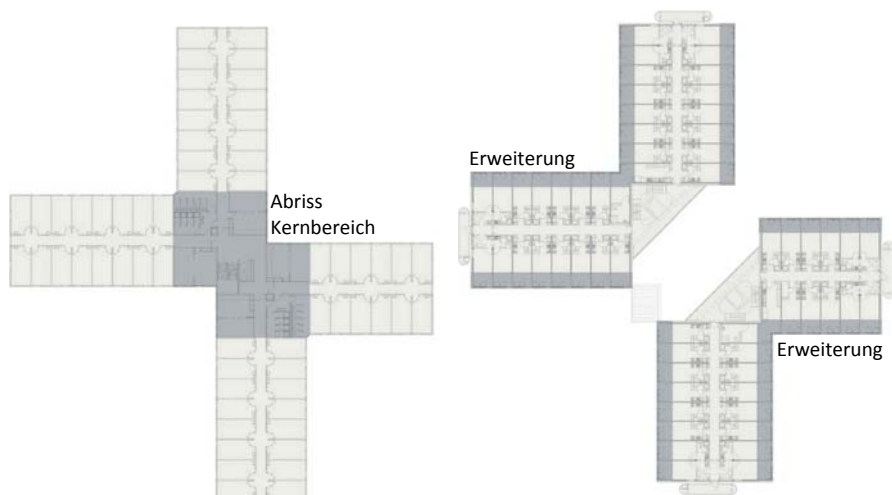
Grundriss eines Gebäudes vor und nach der Sanierung. Der Kernbereich mit Treppenhaus, Küchen und sanitären Anlagen wurde entfernt. Raum für Küchenzeile und Duschbad in den Apartments wurde durch die Erweiterung des Rohbaus mittels der vorgesetzten Wabenstruktur gewonnen.
